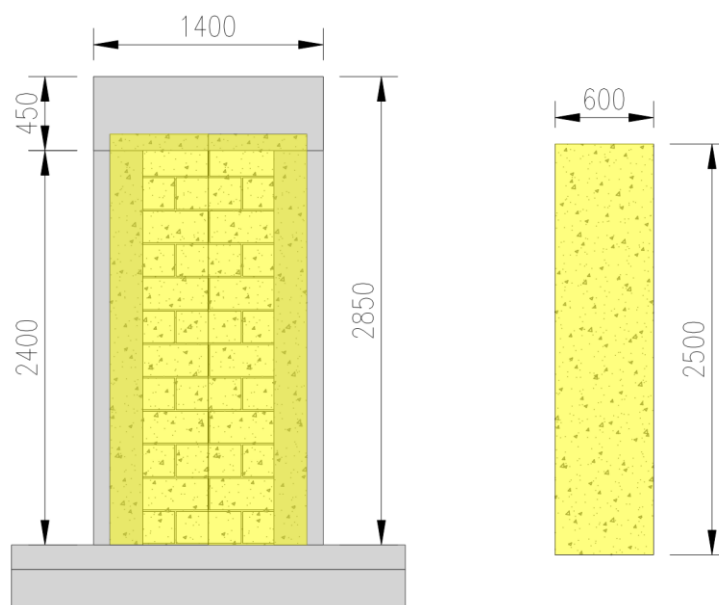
Dimensiones de la plantilla o stencil de vinil autoadhesivo (600mmx 2500mm).
